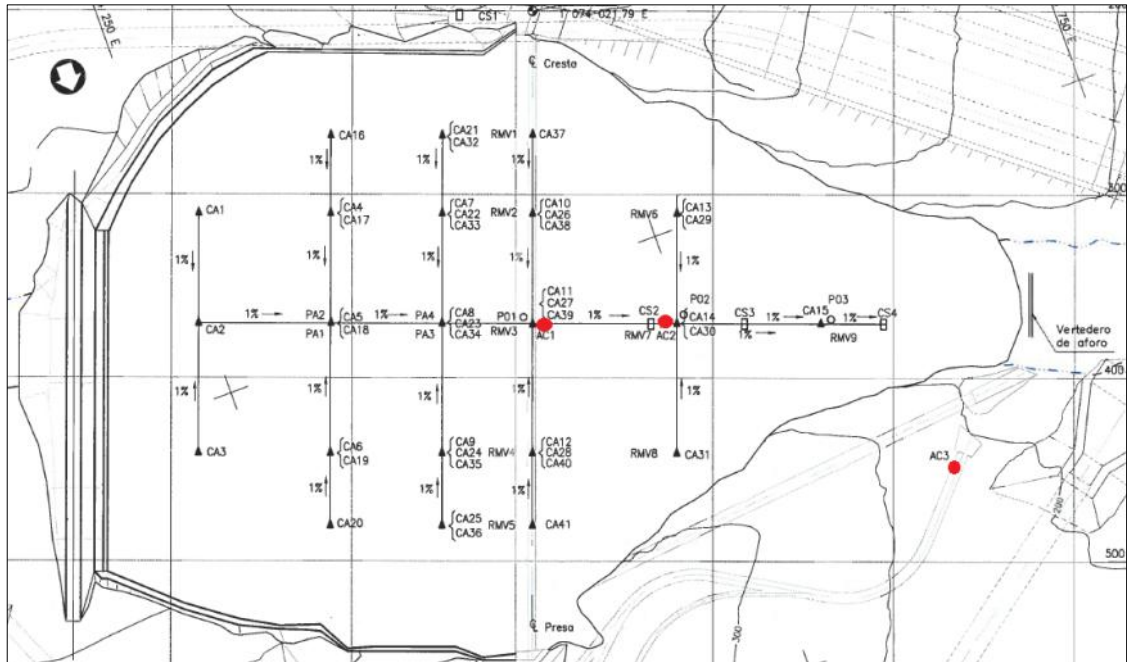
Localización de instrumentación en la pantalla de concreto.
